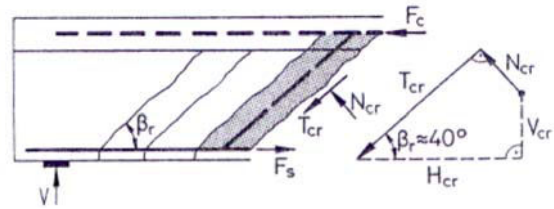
Endauflager eines Balkens mit am Schrägriss angreifenden Kräften nach Reineck [zilc_1]
